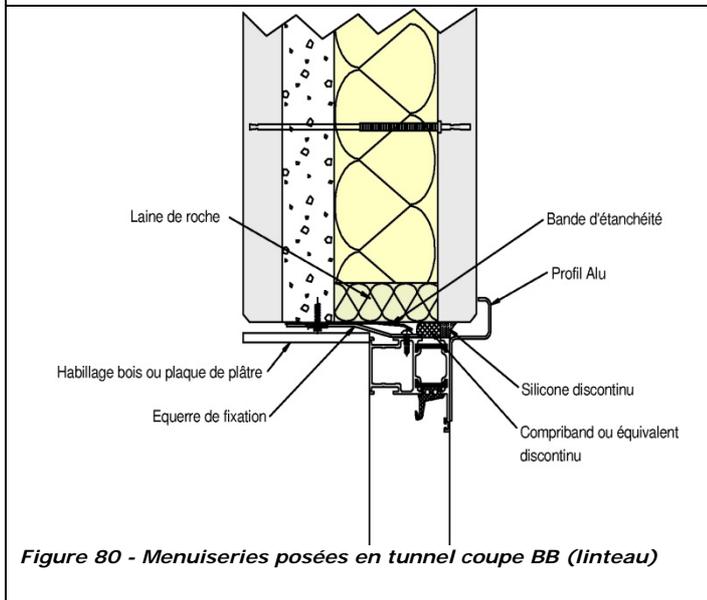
Menuiseries posées en tunnel coupe BB (linteau)
